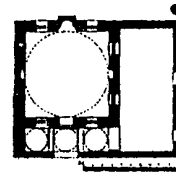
مسقط أفقى لمسجد المرادية
